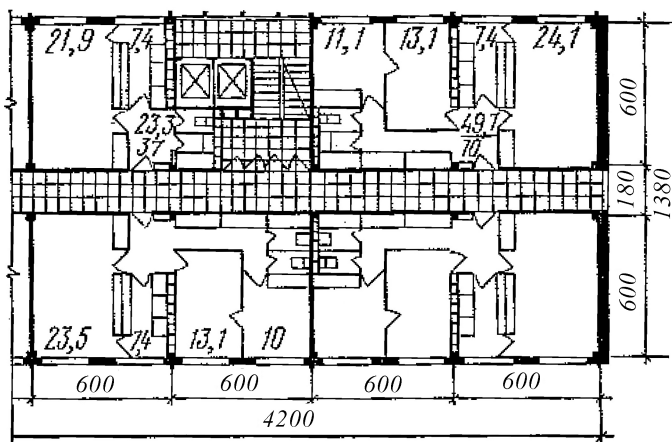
Фрагмент плана 16-этажного каркасно-панельного жилого дома коридорного типа
